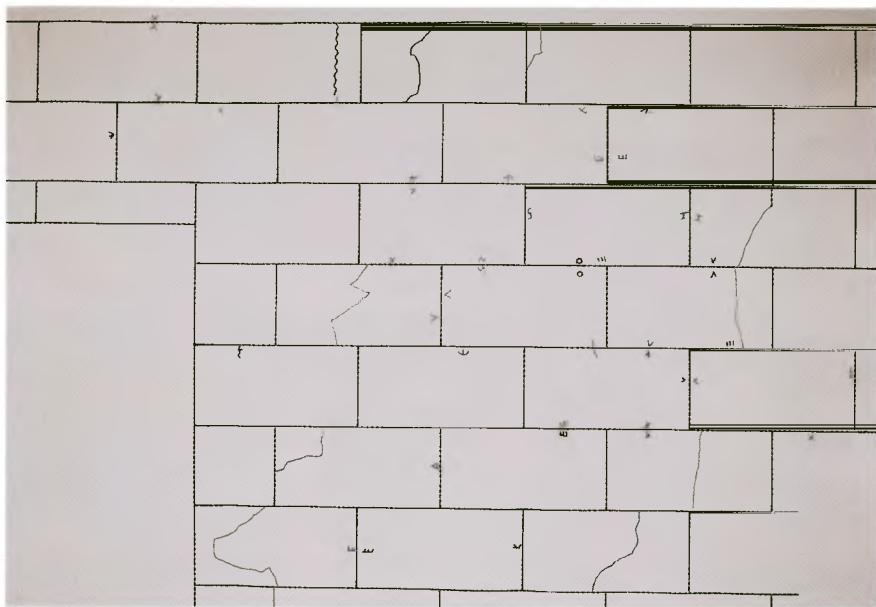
Brescia, *Capitolium*, pièce latérale gauche. Détail du relevé du pavement avec les marques incisées sur les dalles.
